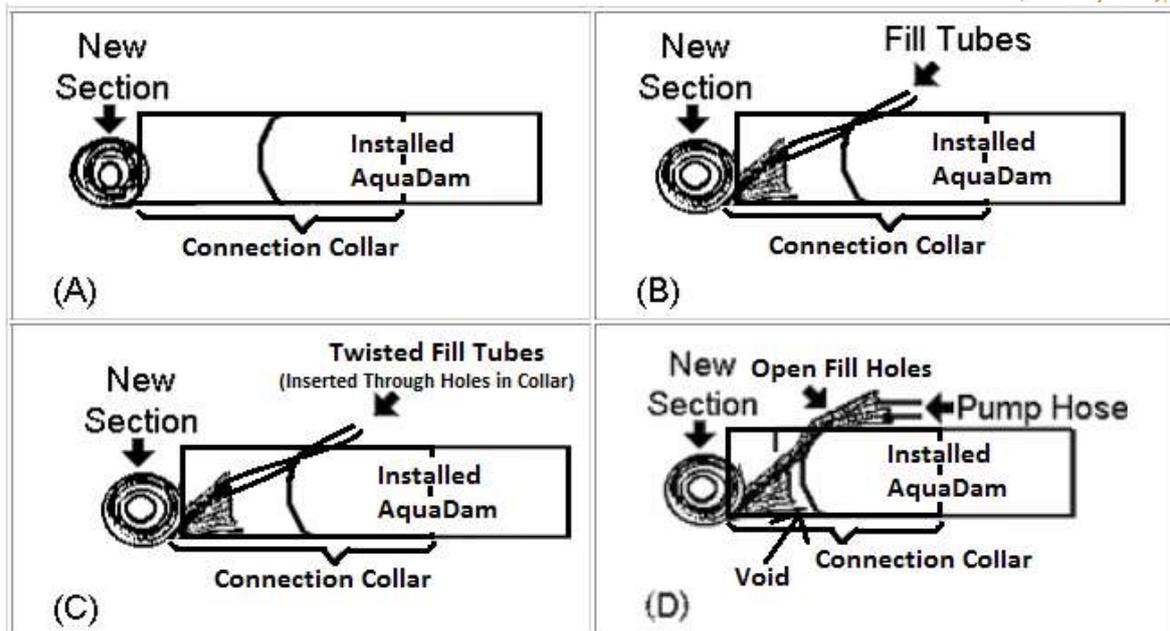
Esquema de conexão do Aquadam entre o tubo cheio (“Installed”) e o próximo tubo ainda vazio (“New section”)
